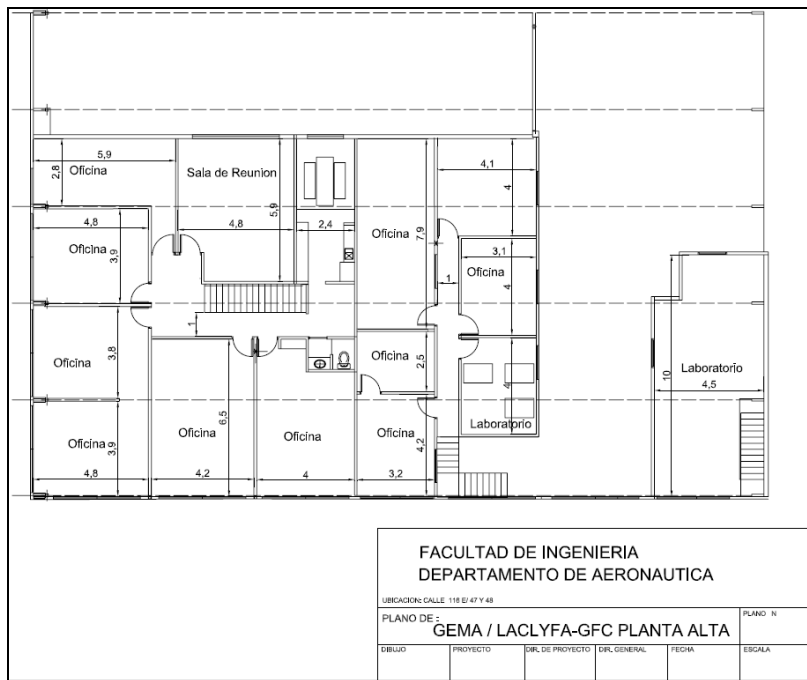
Plano de la planta alta del Edificio (LACLYFA- GFC – GEMA) en obra
